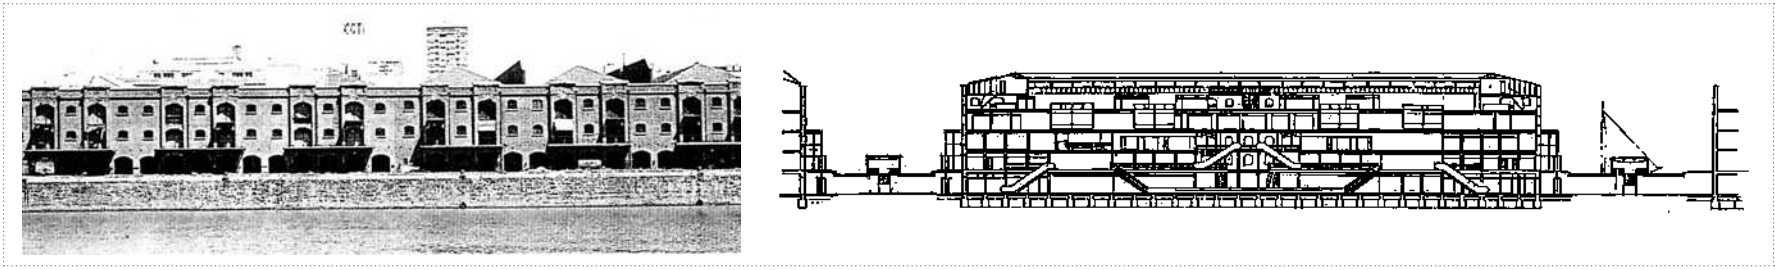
Fachada e corte longitudinal de um depósito portuário antes da revitalização.
